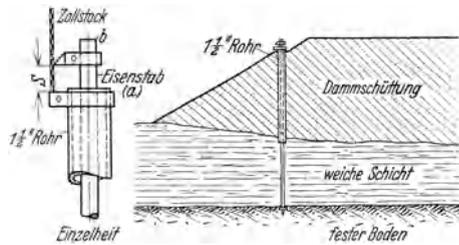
Grundpegel für Dämme. Messung der Dammsetzung geschieht mit Hilfe eines Zollstocks, wenn der Eisenstab (a) fest im Boden sitzt. Andernfalls wird auch der Kopf des Eisenstabes einnivelliert, um die Dammsetzung und die Setzung des Untergrundes zu bestimmen.
